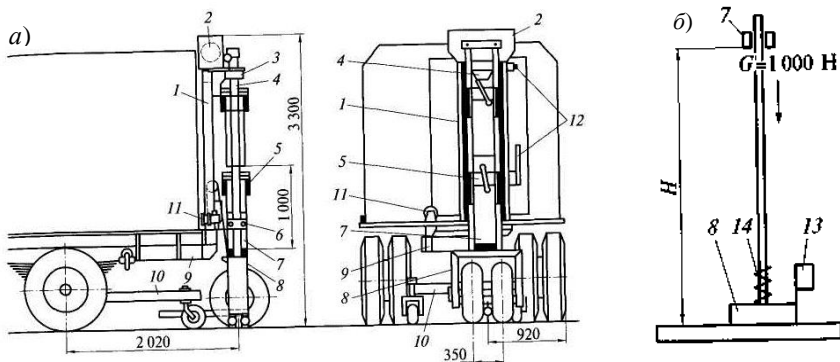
Установка динамического нагружения УДН-НК [62]:
